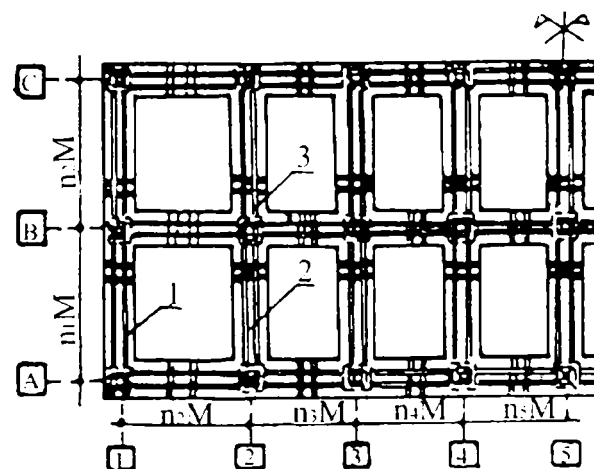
Alcătuirea tălpii fundației din elemente prefabricate: 1- element L; 2 - element T; 3 - element X.
